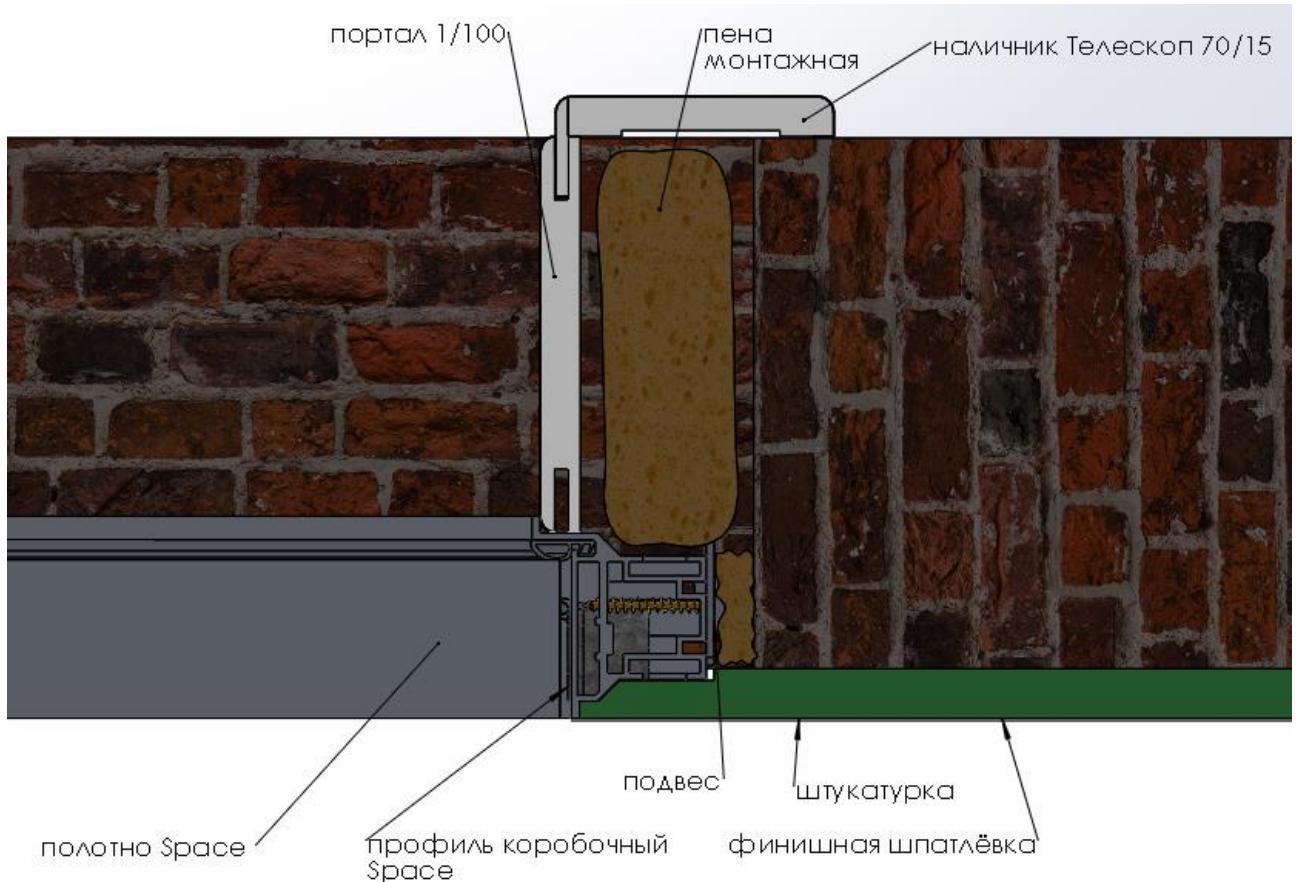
Схема установки дверного блока Space с погонажными элементами
